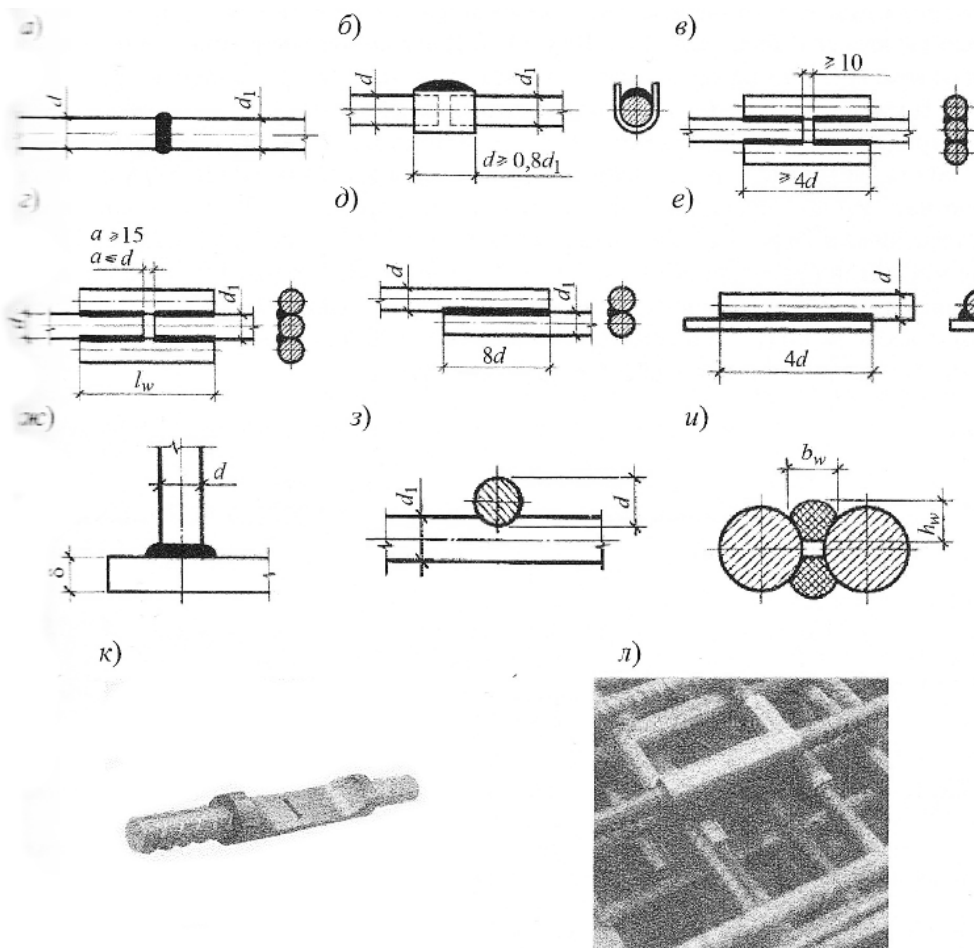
Способы соединения ненапрягаемой арматуры:
